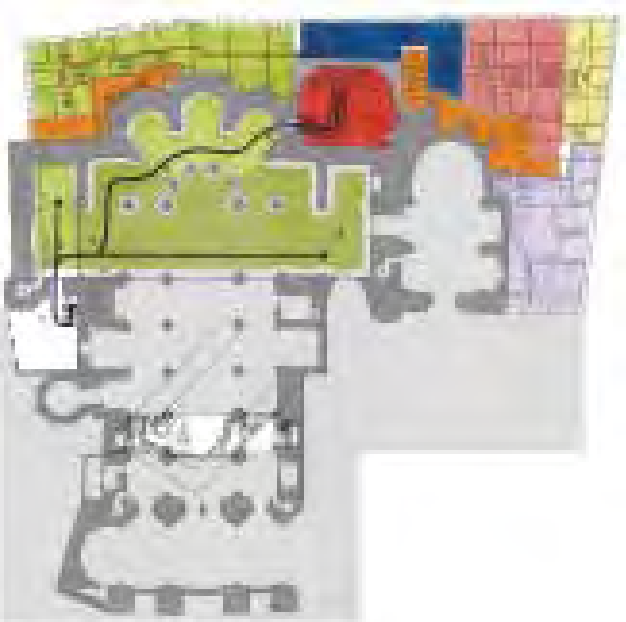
Usos y circulaciones propuestas en la entre planta sótano arqueológico
